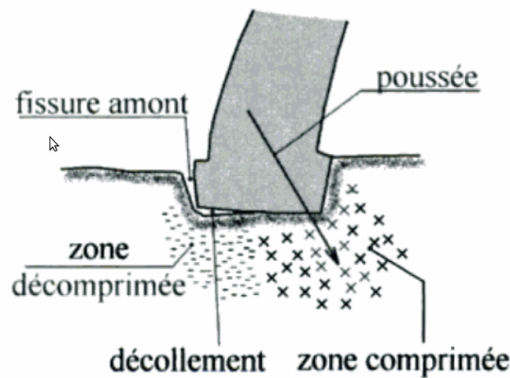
Schéma d'une fissure de pied amont d'un barrage-voûte [Le Delliou, 2003].
